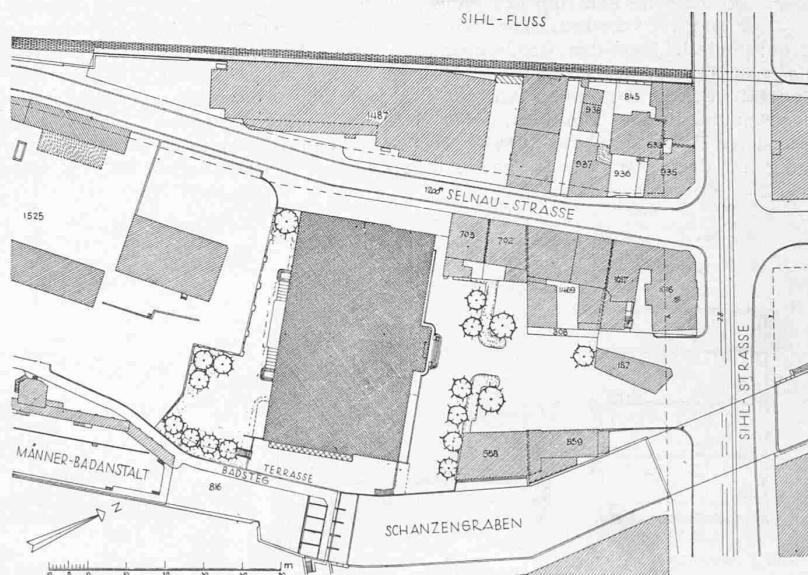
Lageplan 1:1800 des Zürcher Hallenbades (kreuzweise schraffiert)
